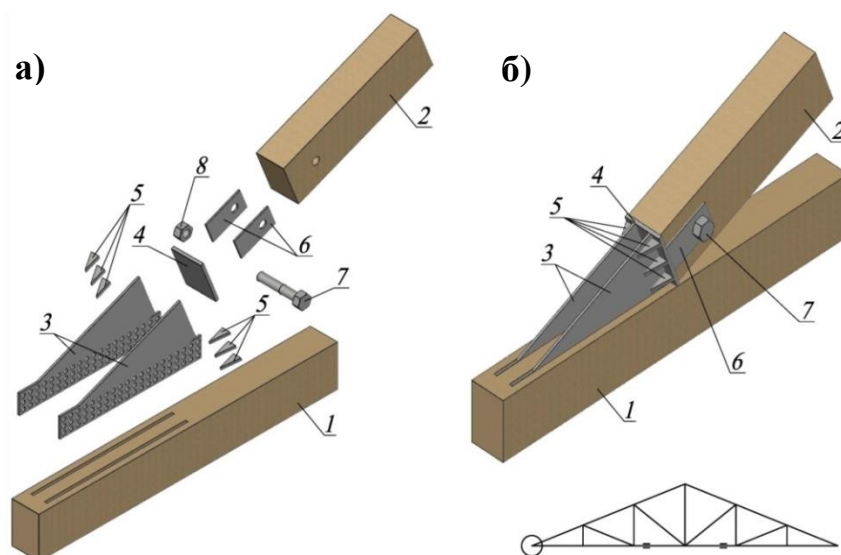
Опорный узел фермы на плоских стальных стержнях в разобранном (а) и собранном (б) виде: 1 – нижний пояс; 2 – верхний пояс; 3 – плоский стержень; 4 – опорная плита; 5 – подкрепляющие ребра; 6 – ограничительные пластины; 7 – болт; 8 – гайка
